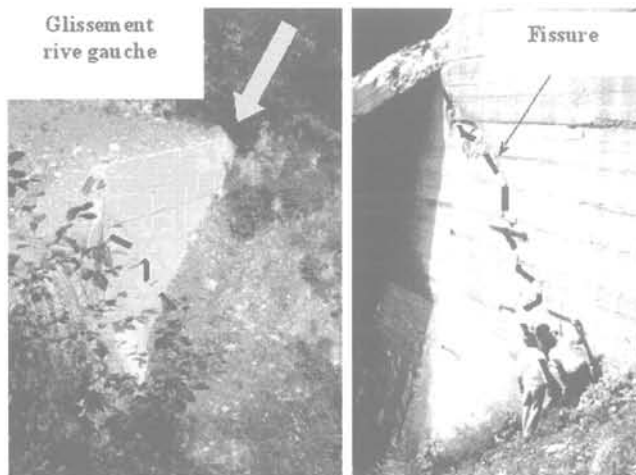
Quelques exemples de fissuration. Examples of fissures.
